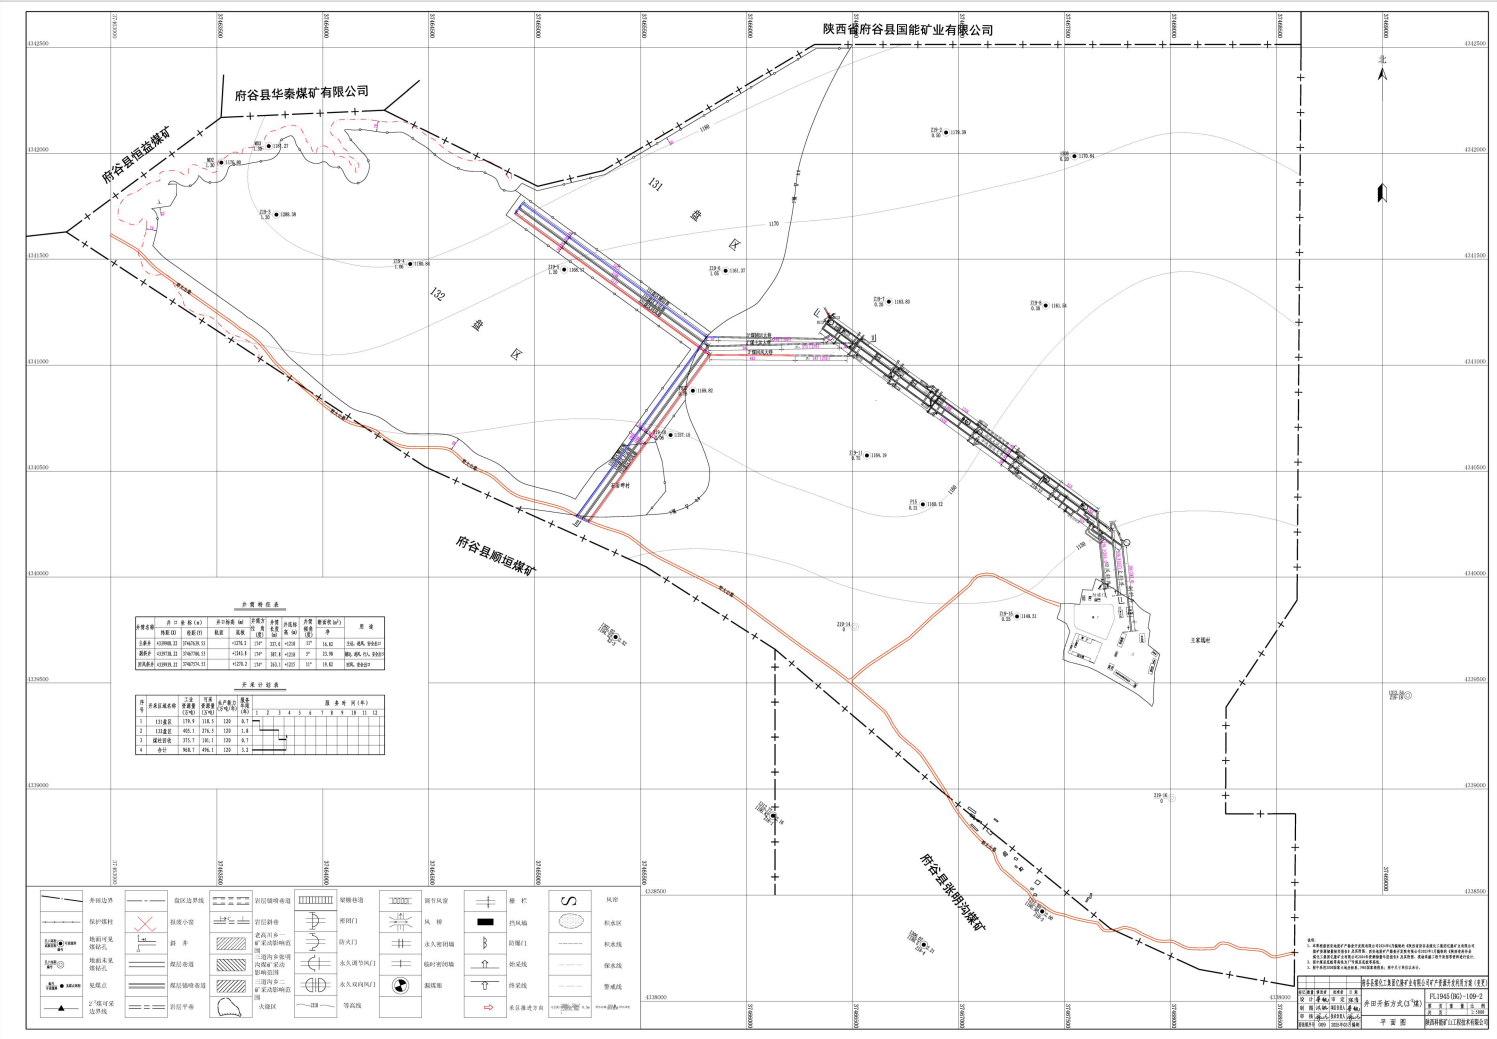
3⁻²煤层保护煤柱留设平面图
